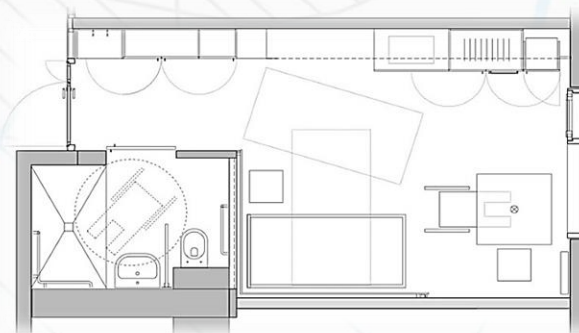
Planta de Habitación Tipo – Archdaily.mx
